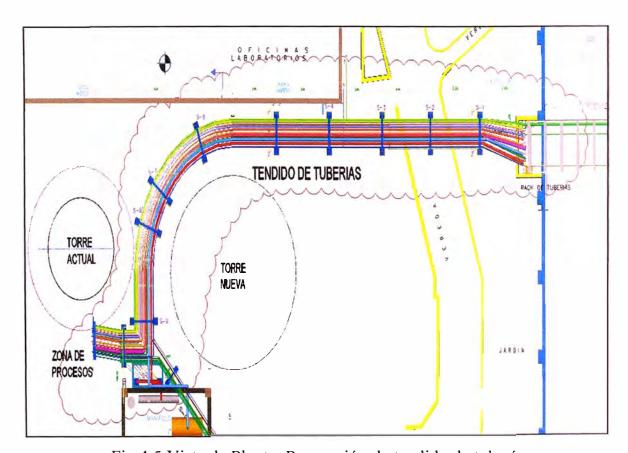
Vista de Planta: Proyección de tendido de tubería
